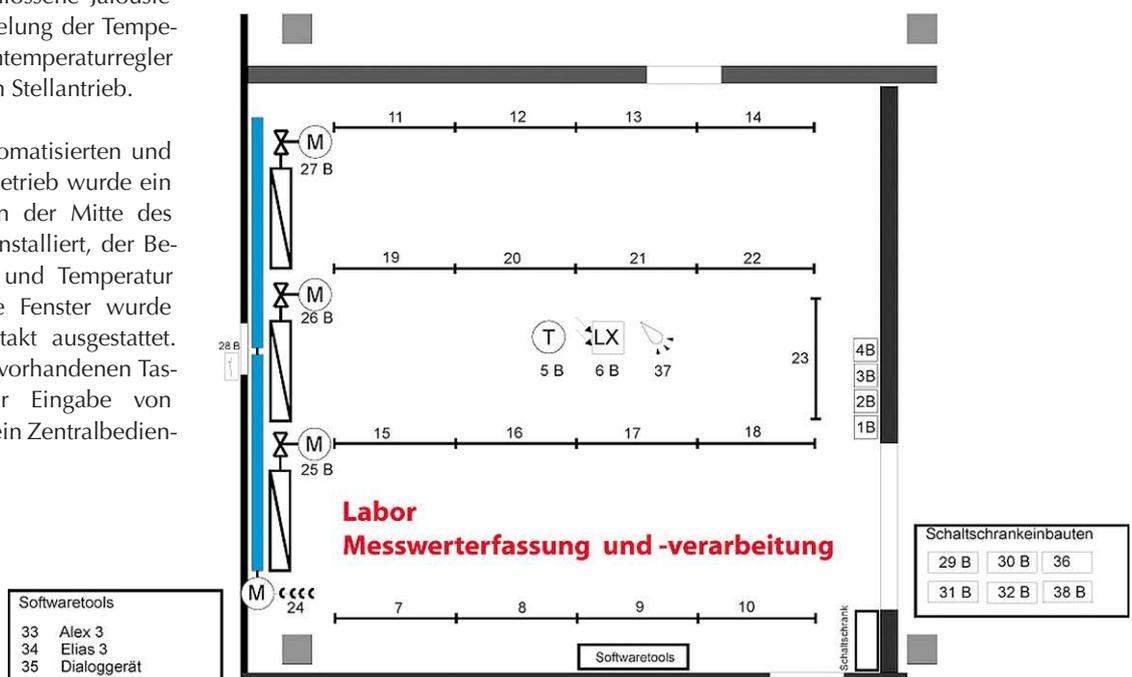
Grundriss des Labors Messdatenerfassung und -verarbeitung mit den Einrichtungen zur Raumautomation
